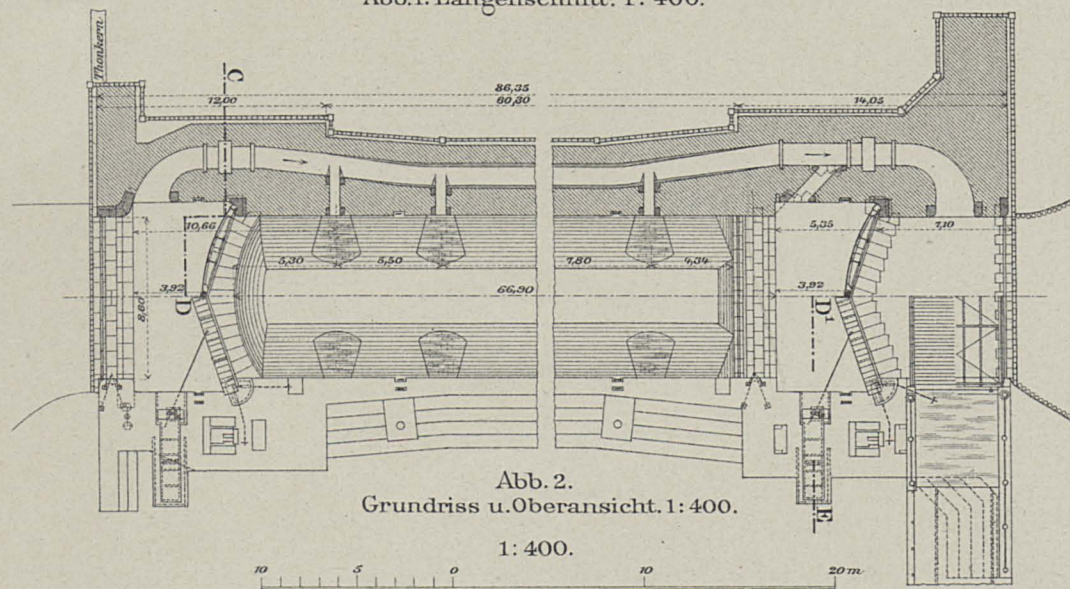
Grundriss u. Oberansicht. 1: 400.
